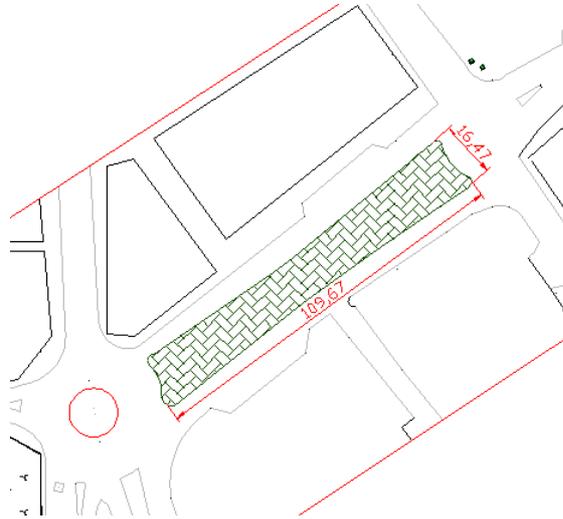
plan de la place de la galerie et ses dimensions
